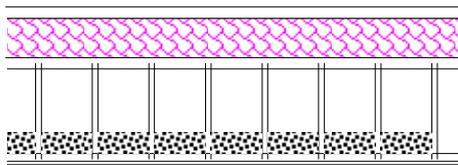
Holzkastenelementdecke mit Schüttung.
